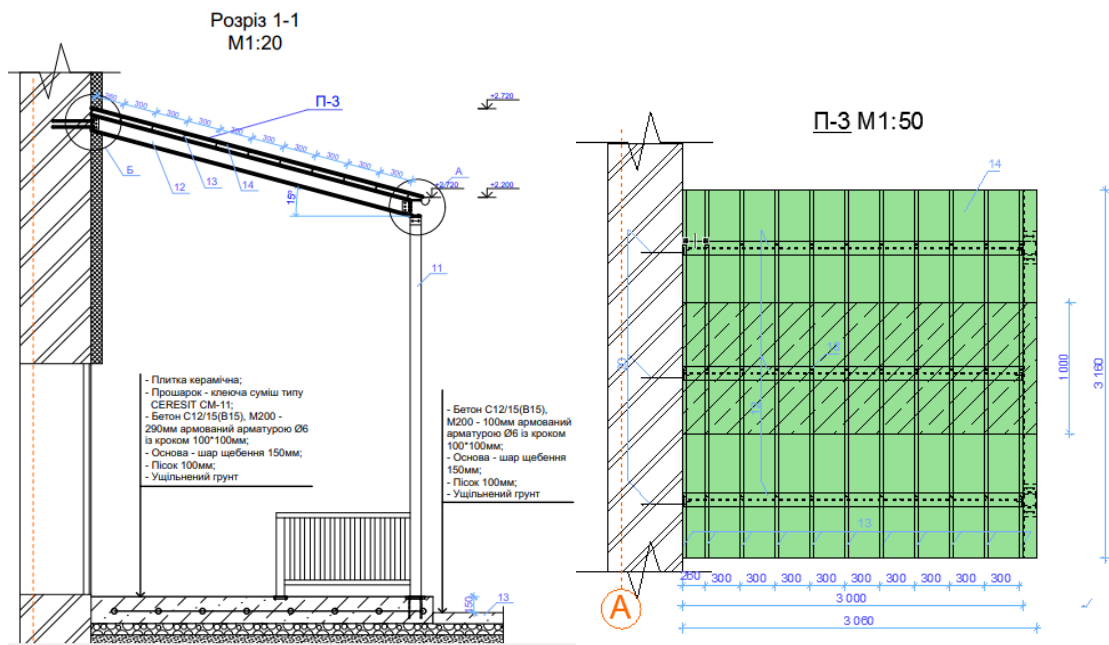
Вигляд в розрізі і зверху козирька із САП конструкції
